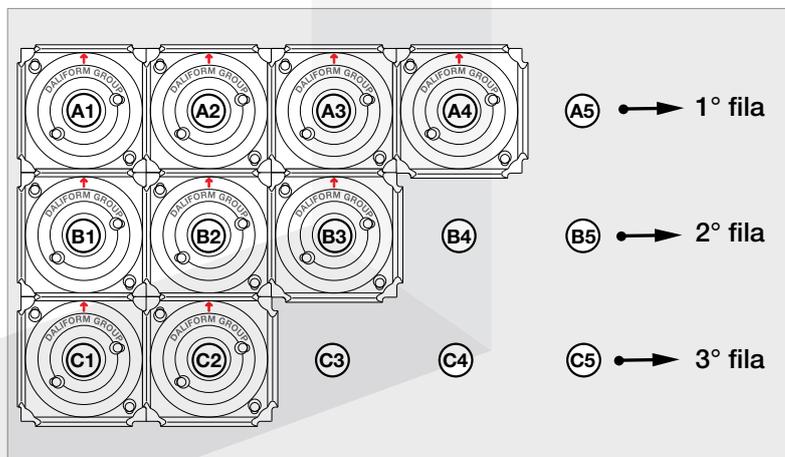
Colocação a seco do primeiro módulo, a seta fica virada para o muro de fundação.
